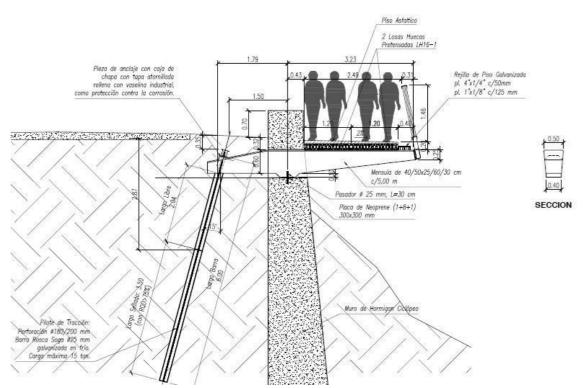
Plano del tramo crítico, donde no hay terreno de apoyo.
